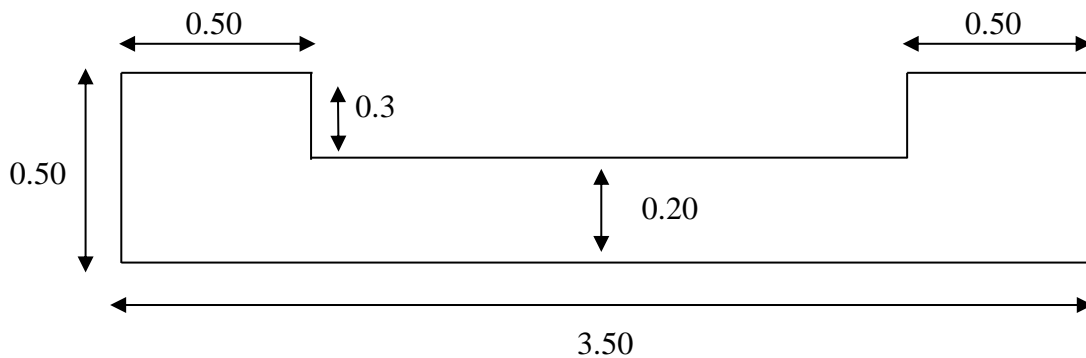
Voile plein de forme rectangulaire avec deux poteaux.
